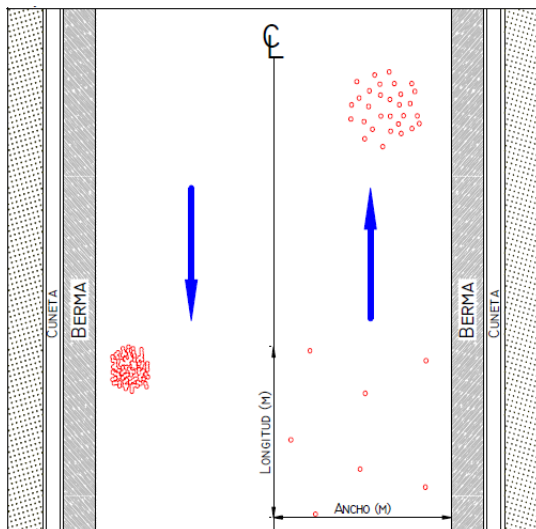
Pérdida de agregado sobre pavimento asfáltico existente.
